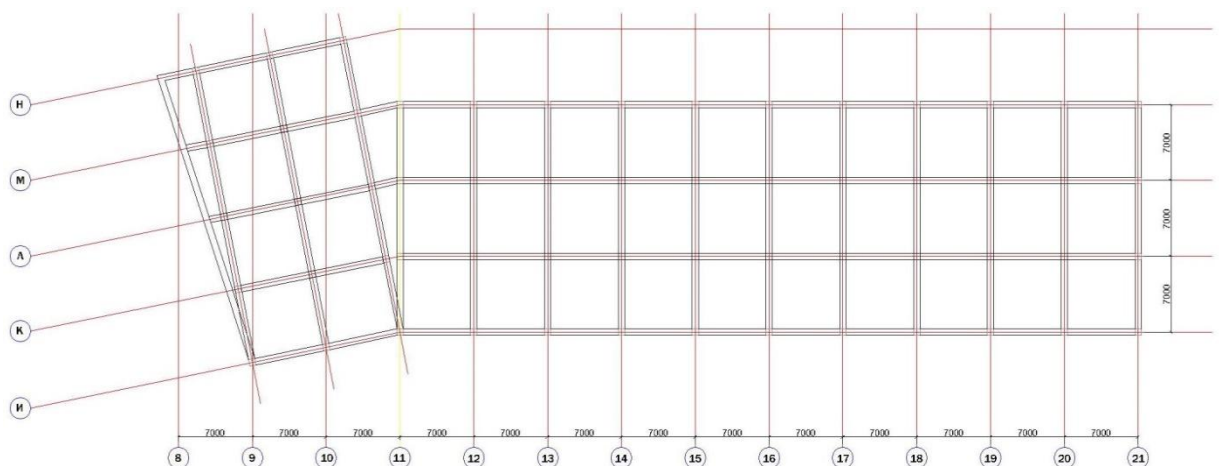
Конструктивная схема монолитного ребристого перекрытия с главными балками в продольном направлении
